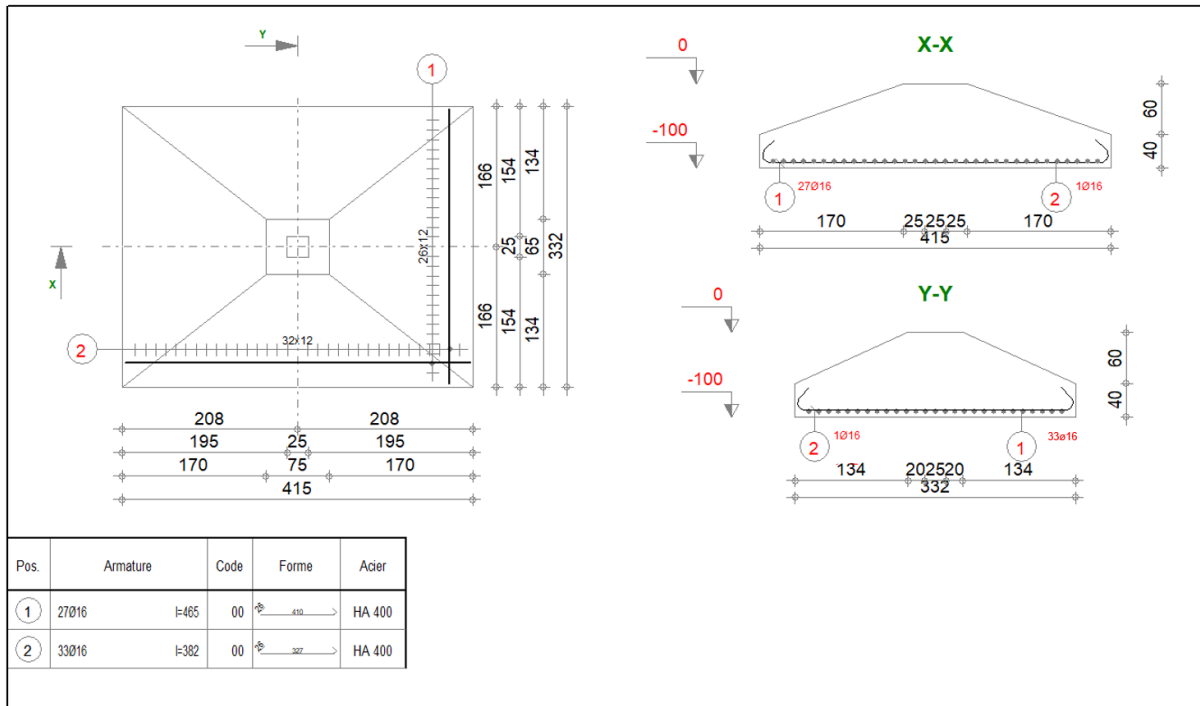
Ferrailage de la fondation du poteau et ces dimensions
